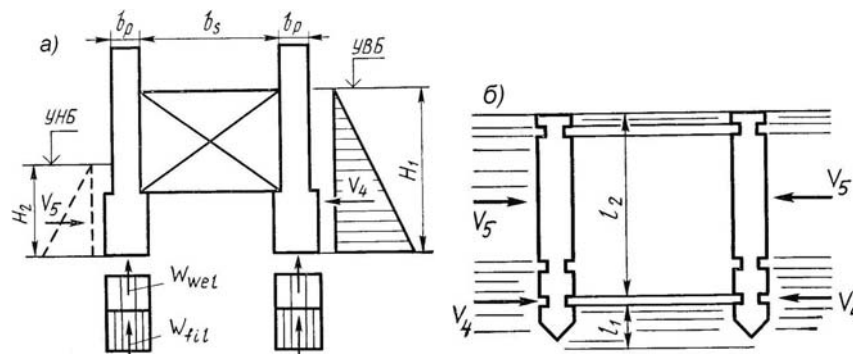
Схема расчета быка в случае ремонта: а - вид ВБ; б- план
